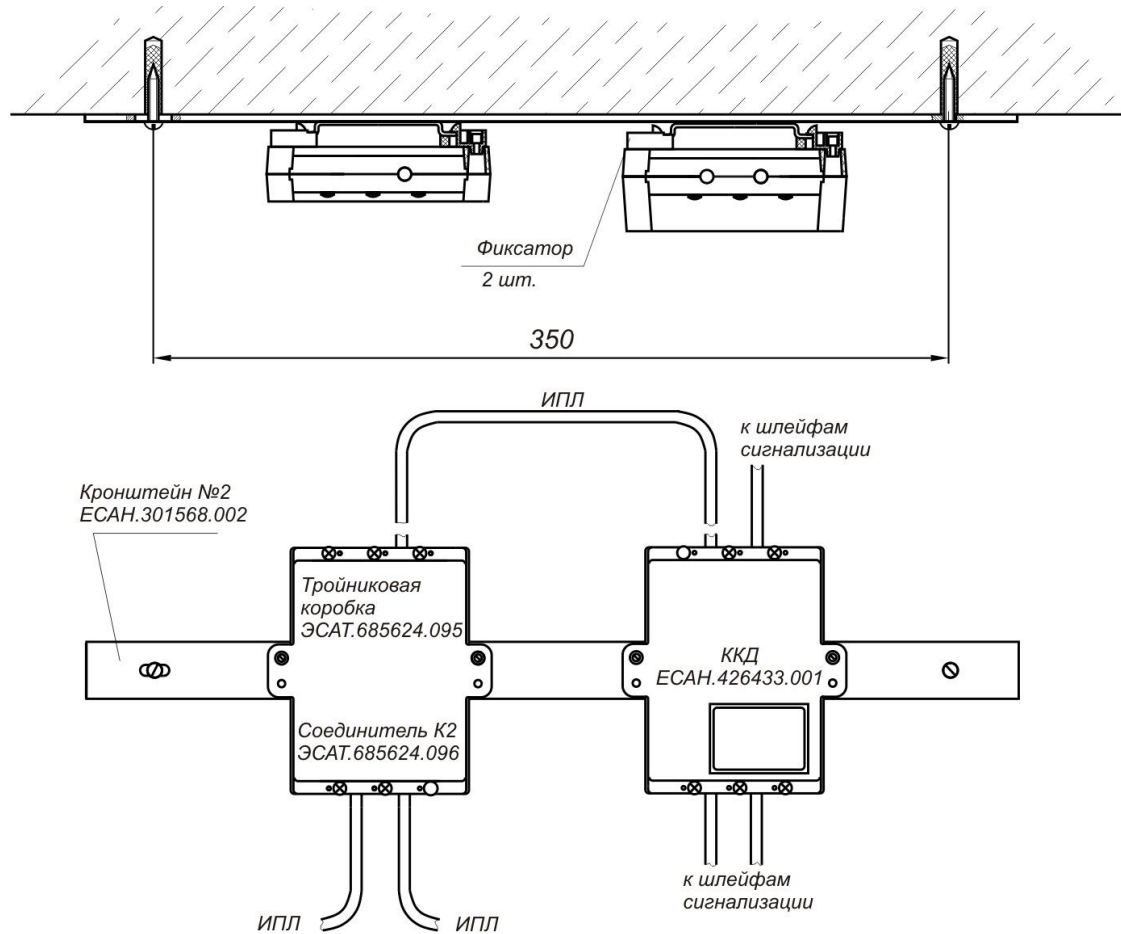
Установка ККД и тройниковой коробки на кронштейн №2
